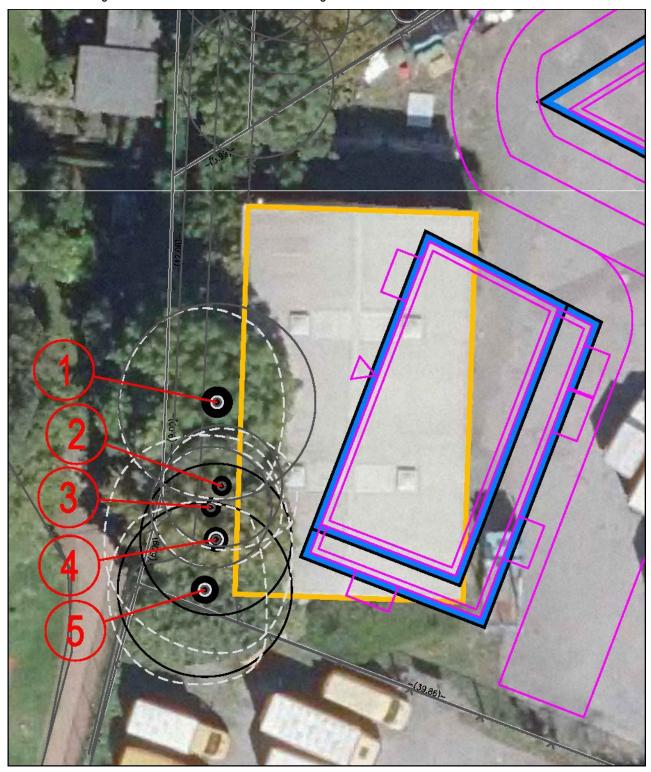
Vorhandener Baumbestand mit heutiger Gewerbehalle (gelb) und überlagerter Planung
